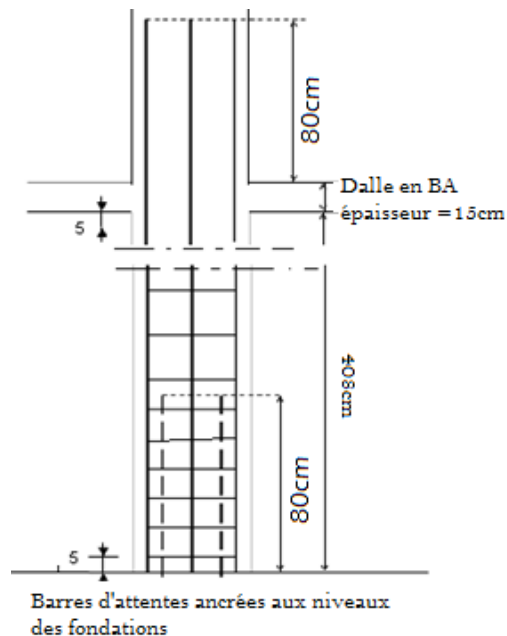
Schéma de ferrailage des poteaux du rez-de-chaussée.
